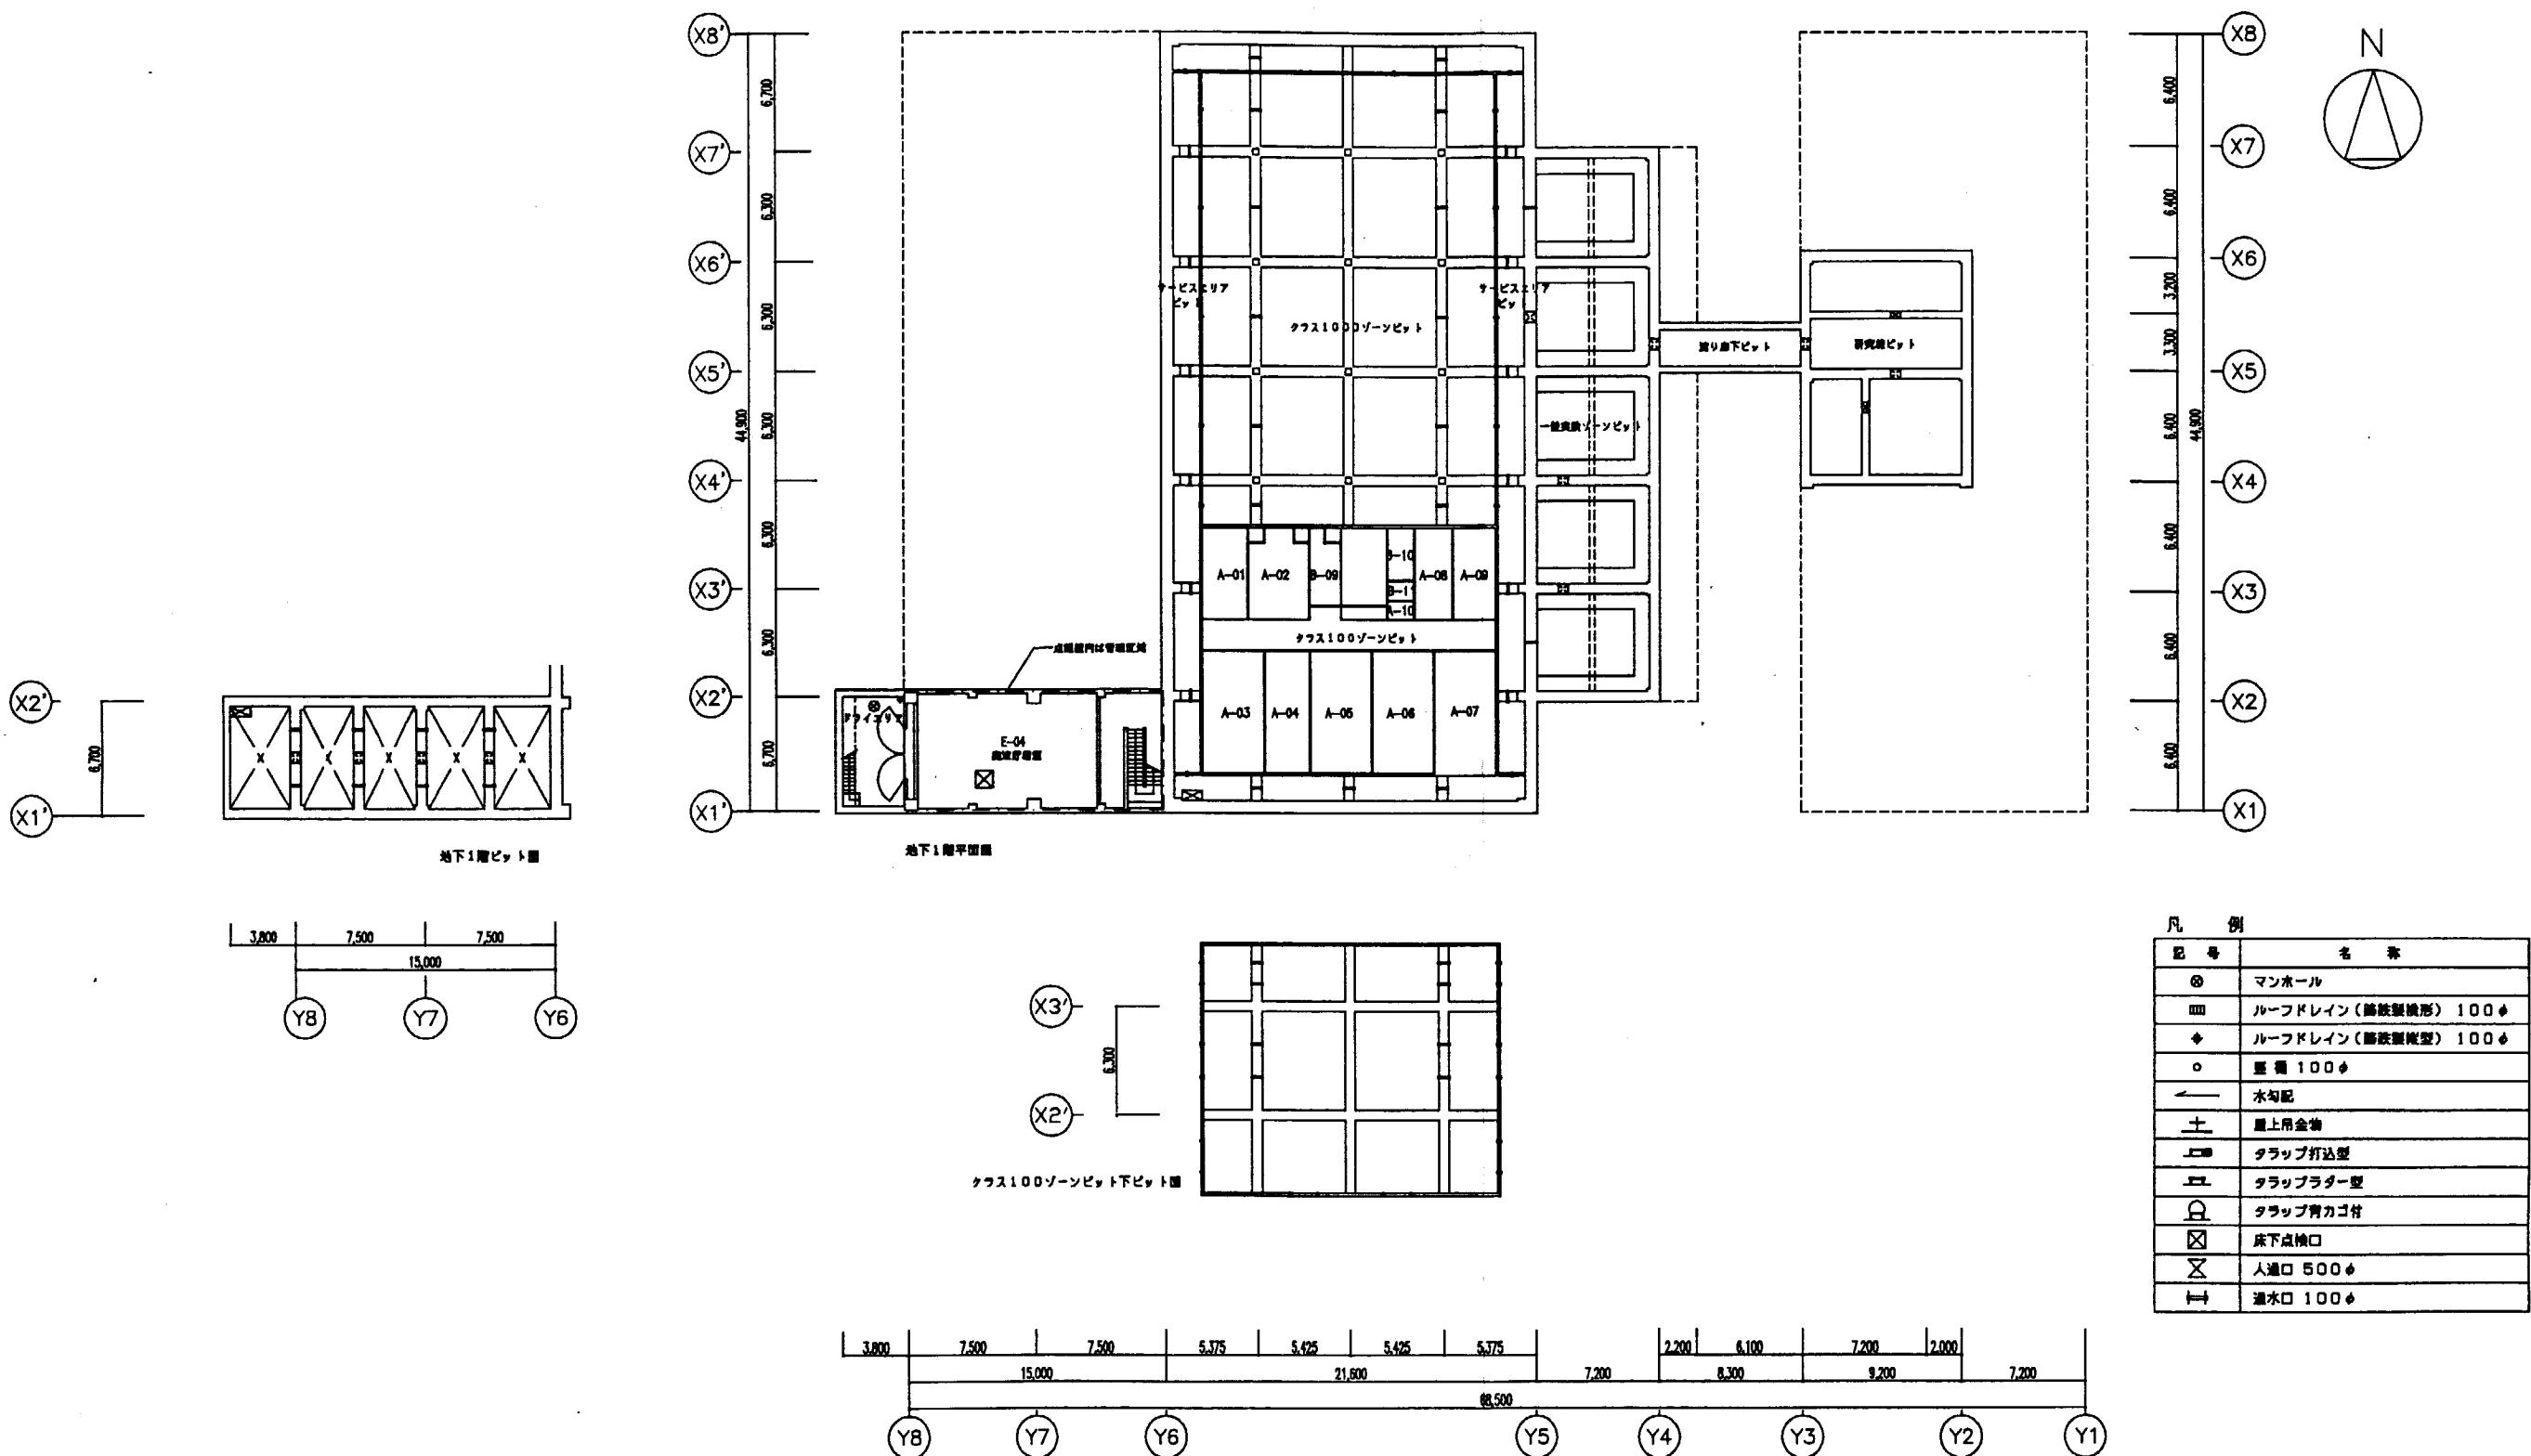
CLEAR平面図 (a) 地下1階、ピット平面図
